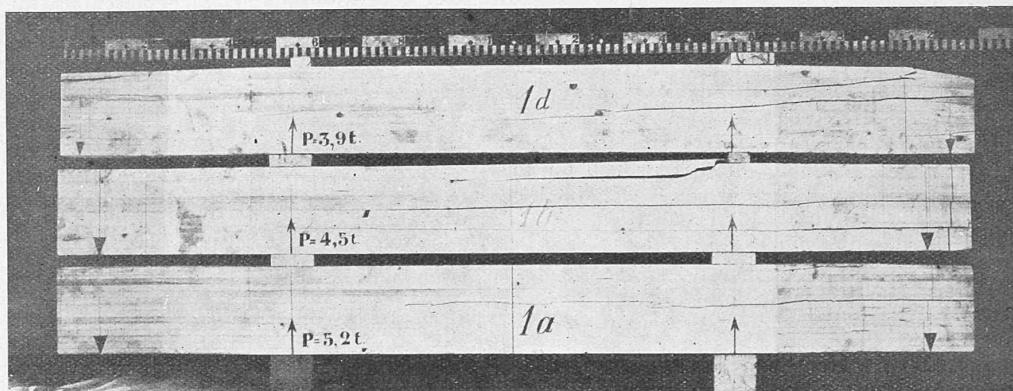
Ansicht der Probekörper Typ 1 nach dem Bruch.
